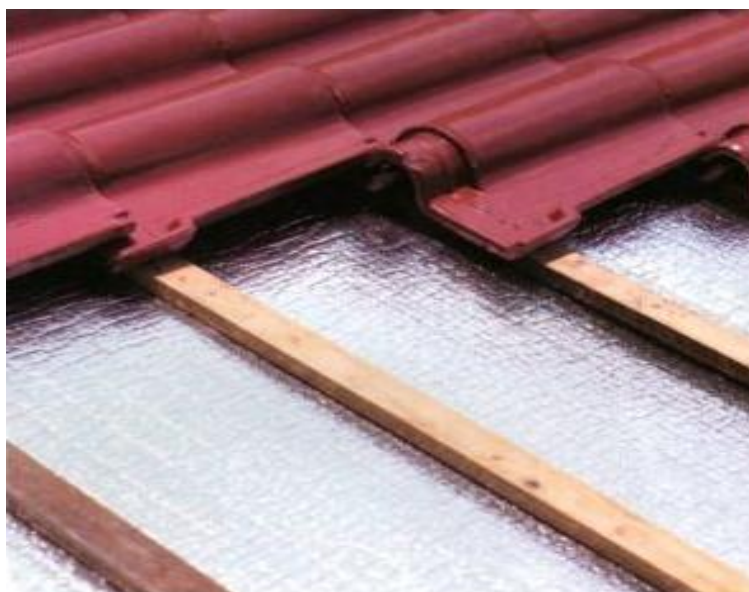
Sistema de manta subcobertura para isolamento térmico e impermeabilização de telhados
